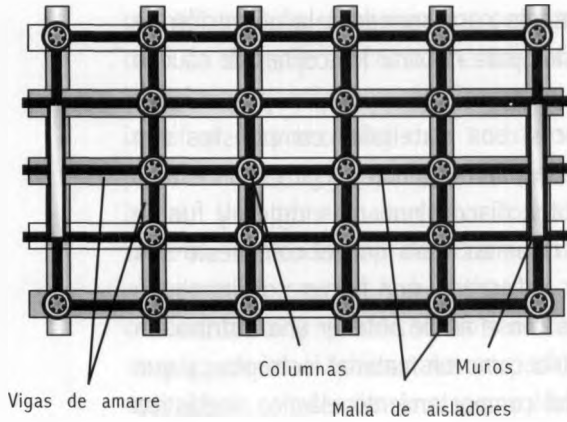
Distribución de aisladores de caucho longitudinales para distribuir uniformemente las cargas verticales.
